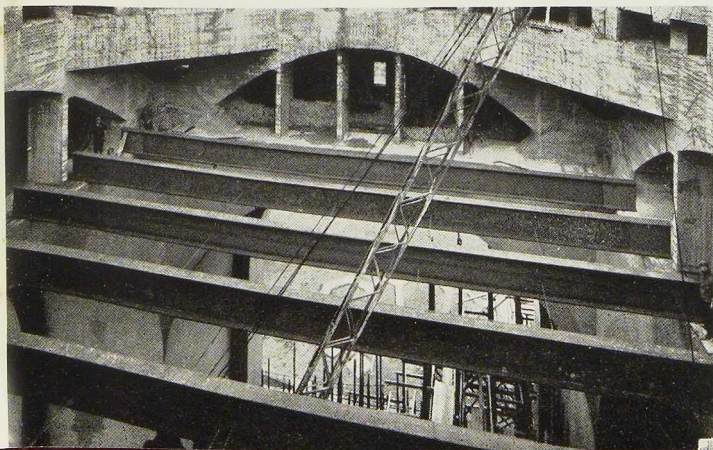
Vue d'ensemble de la poutraison du plancher de travail qui se trouve à plus de 30 mètres de hauteur au-dessus du niveau du rez-de-chaussée.
